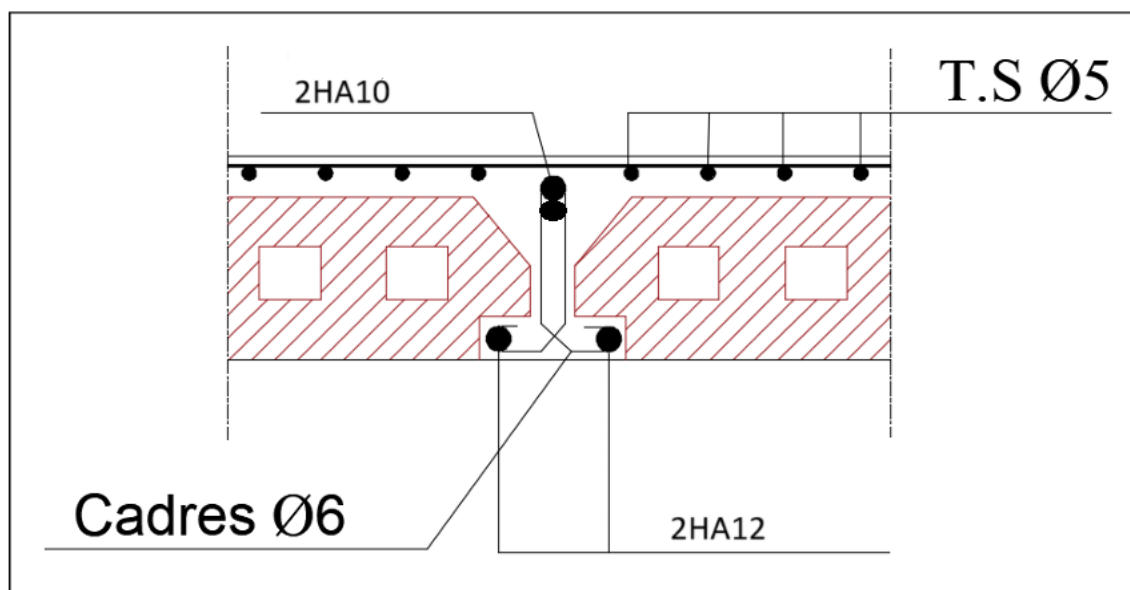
Schéma de ferrailage des poutrelles des planchers à corps creux
